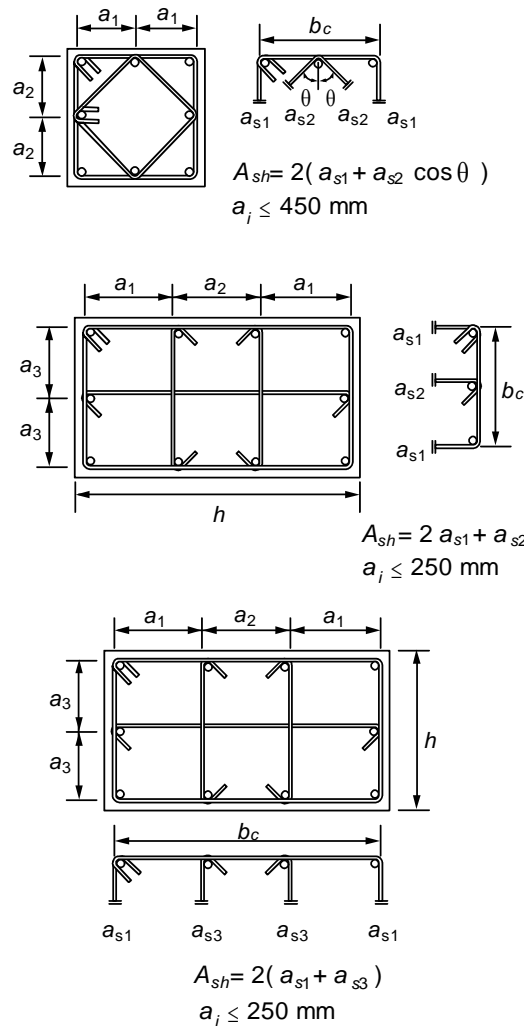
Determinación de la cuantía de refuerzo transversal en miembros a flexocompresión
